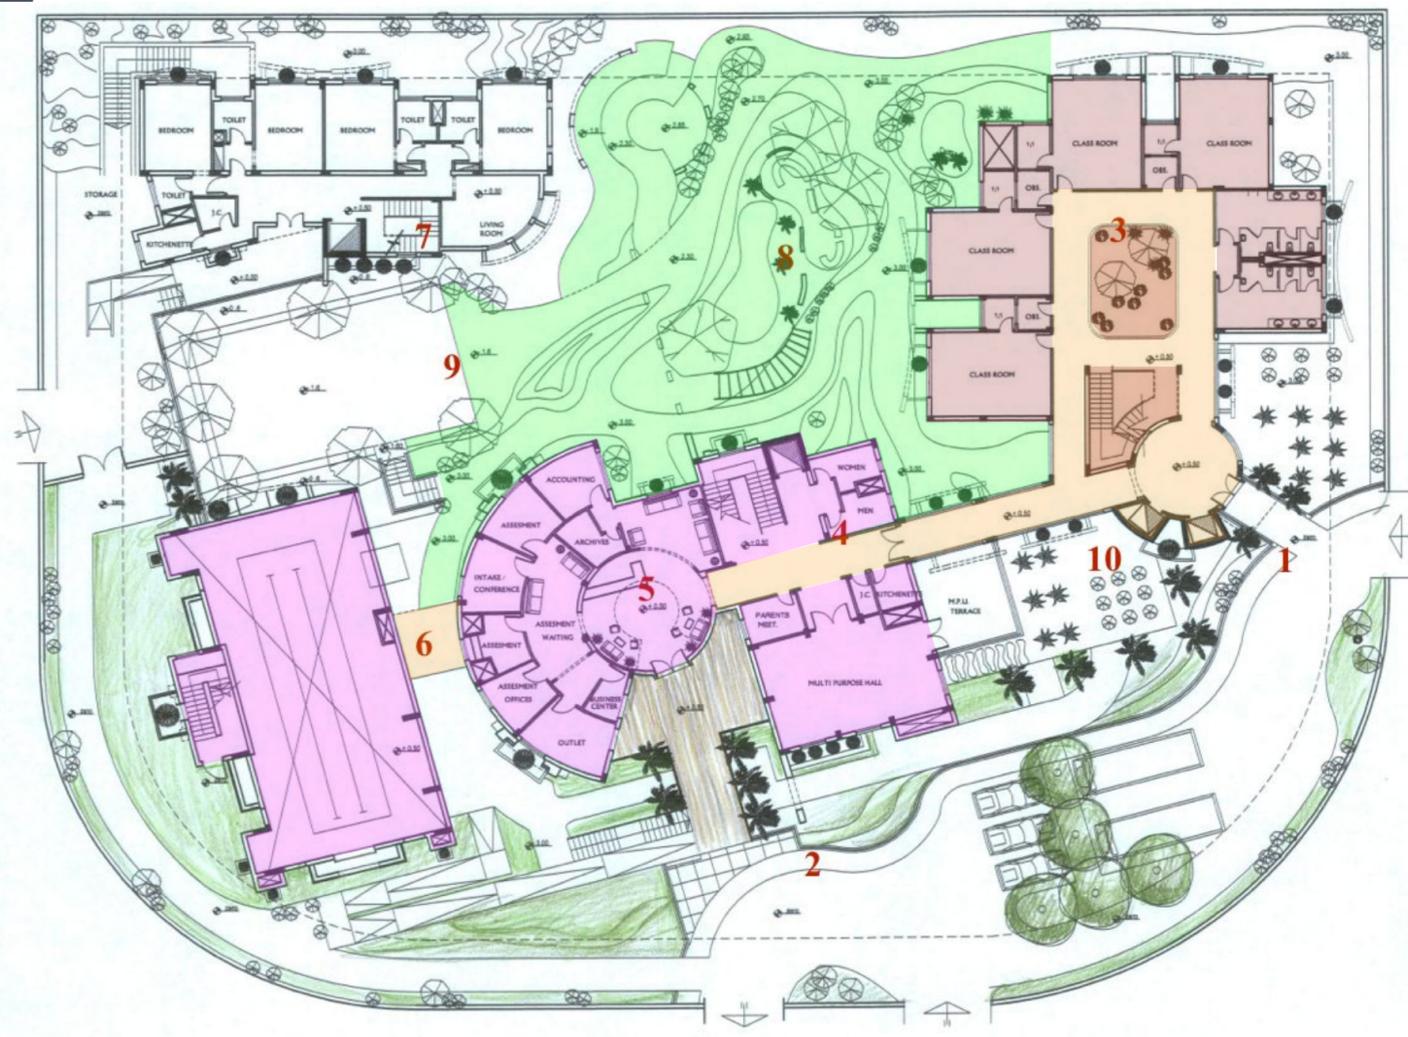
Planta Baixa - *Advanced Special Need Education*, Qattameya, Cairo | Fonte: Archdaily, 2013. Adaptado pela autora.
